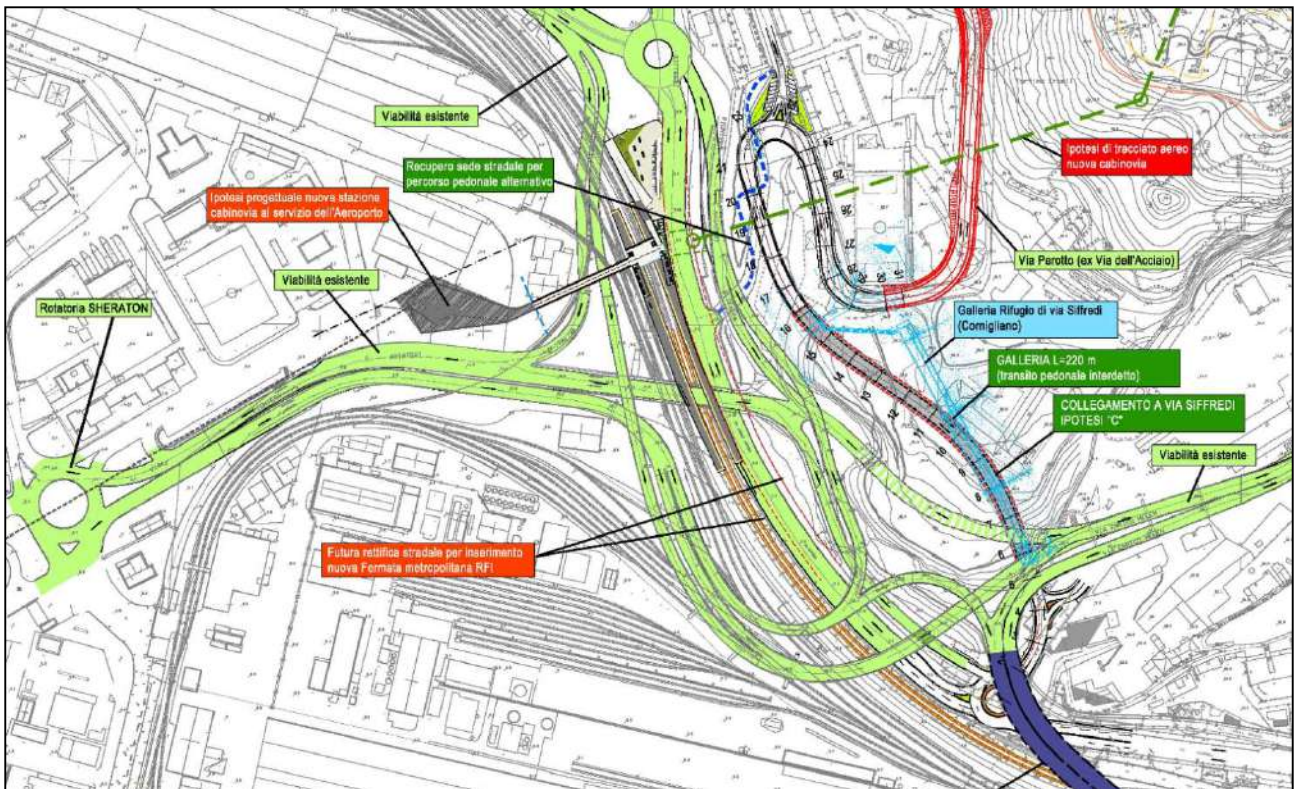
Layout del nuovo collegamento mediante tunnel verso via dell'Acciaio
